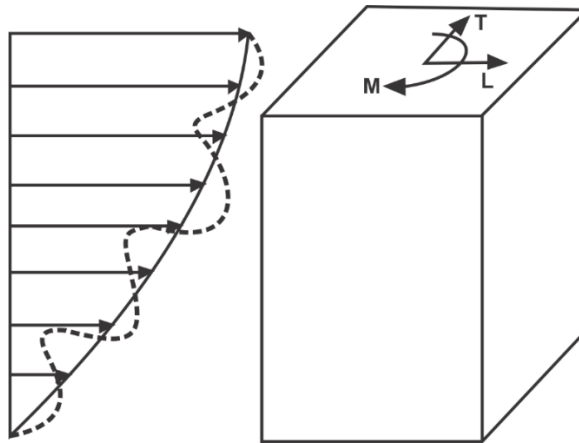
Pressão do vento causando deslizamento e tombamento
